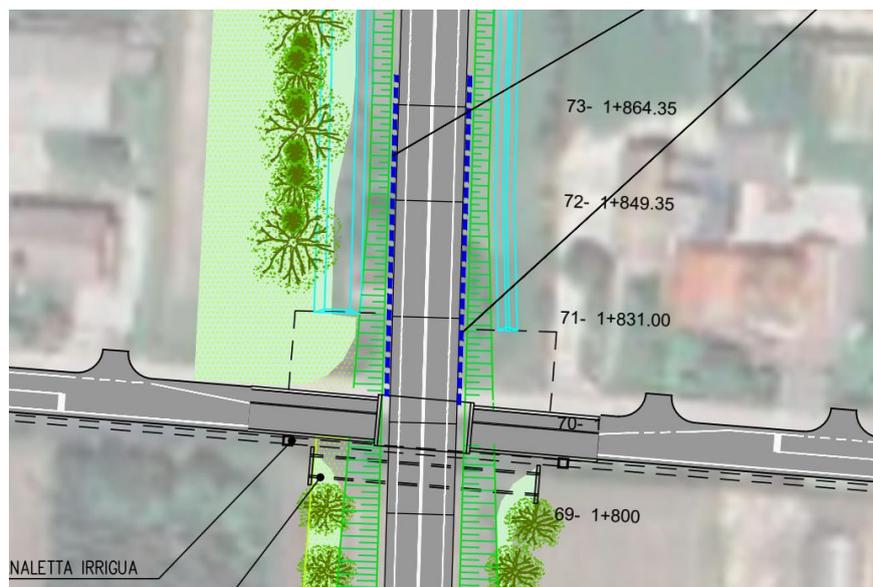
Posizionamento delle barriere acustiche (segnate in blu) a protezione dei ricettori R10, R11, R12, R35 e R36 in prossimità dell'attraversamento del Cavetta.
